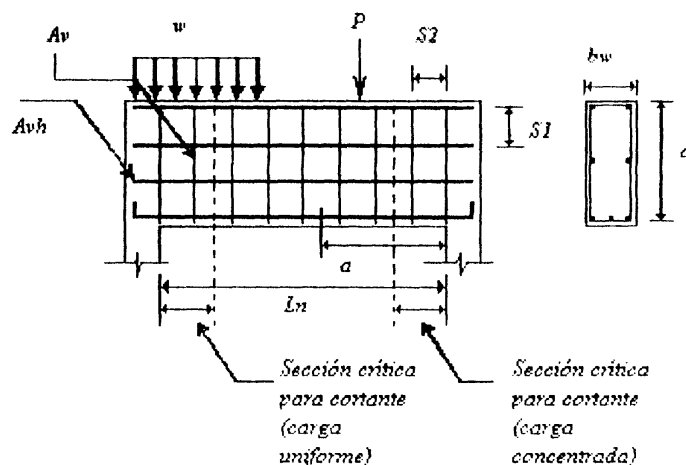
Detalle de diseño para vigas diafragma simplemente apoyada.
